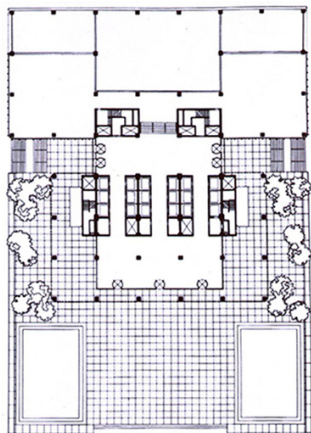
Edificio Seagram Building. Fuente: Plataforma Arquitectura
